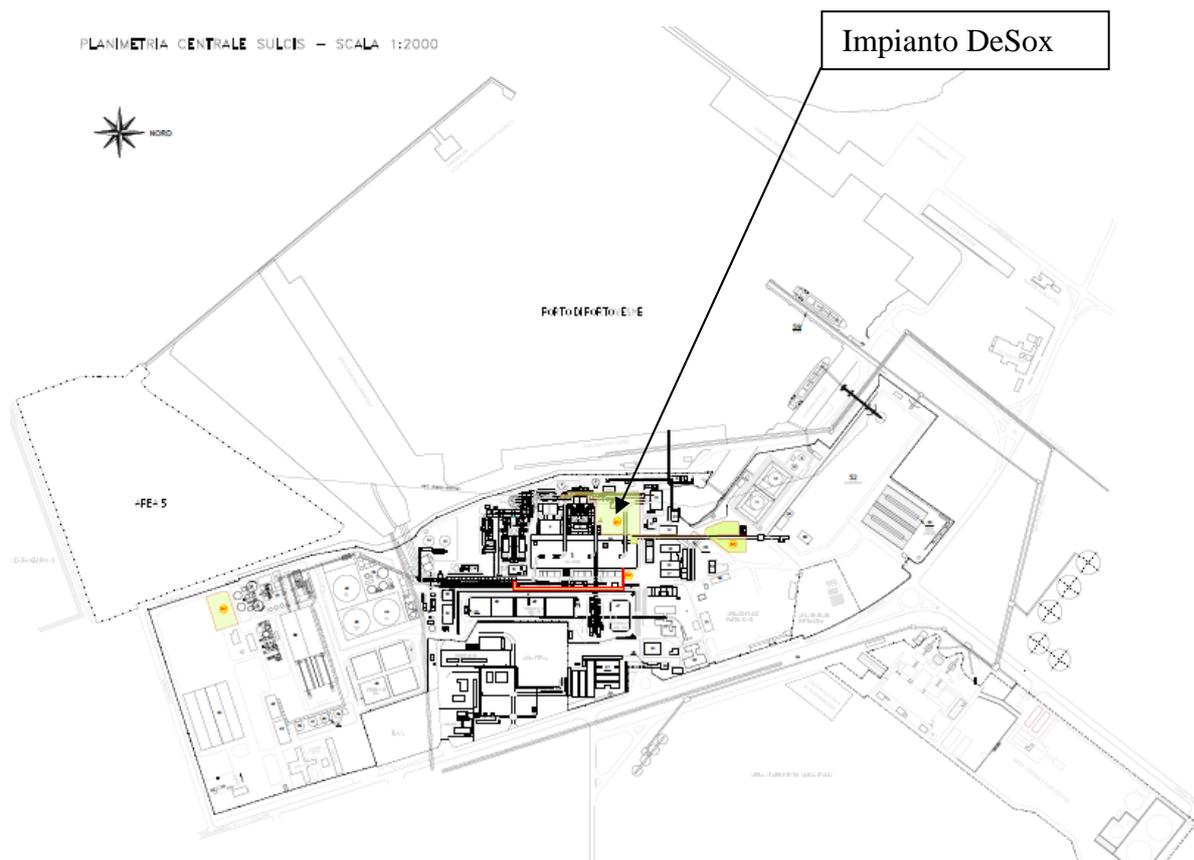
Pianta schematica della centrale termoelettrica di Sulcis con indicazione dell'area d'intervento
